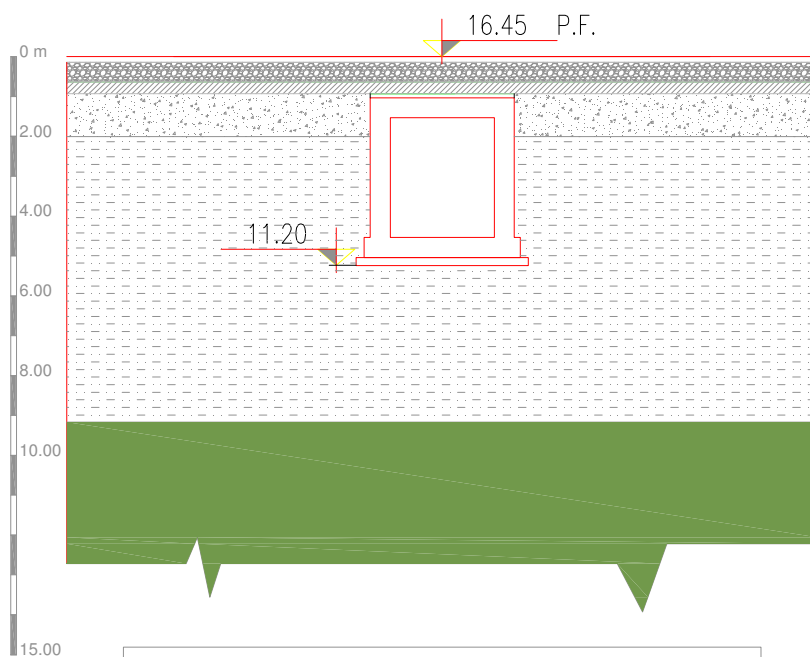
/A : BARLETTA SCALO - PROFILO GEOTECNICO IN ASSE AL SOTTOPASSO
